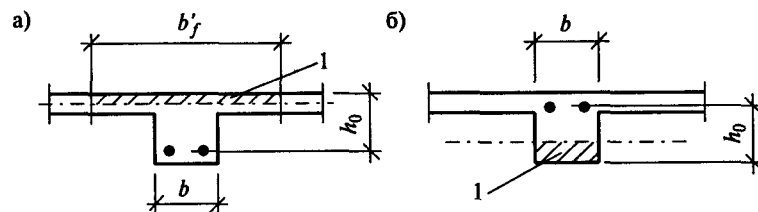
Расчетные сечения балок: а) в пролете (тавровое);
